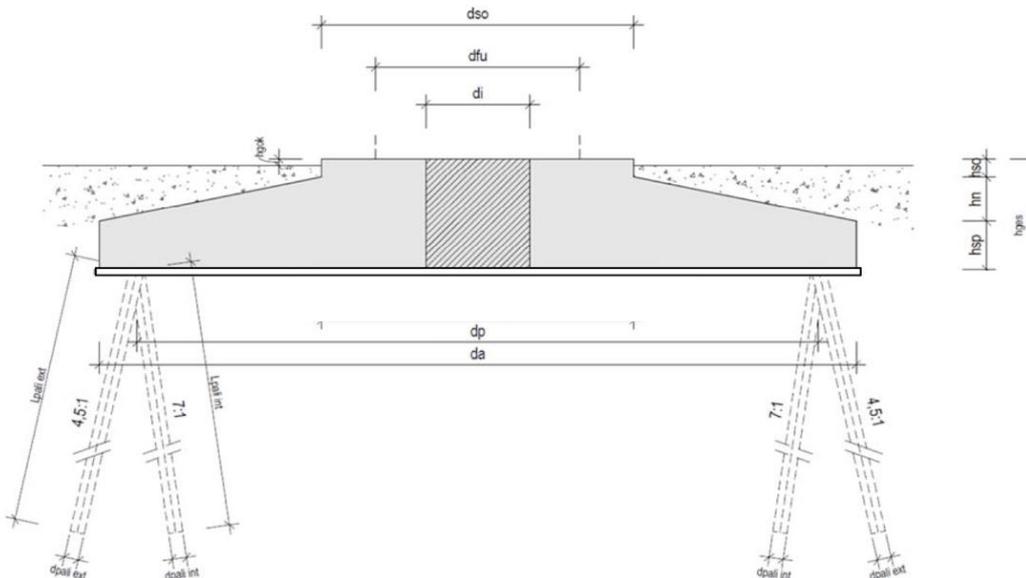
Andamento geometrico della fondazione (sezione – non in scala).
